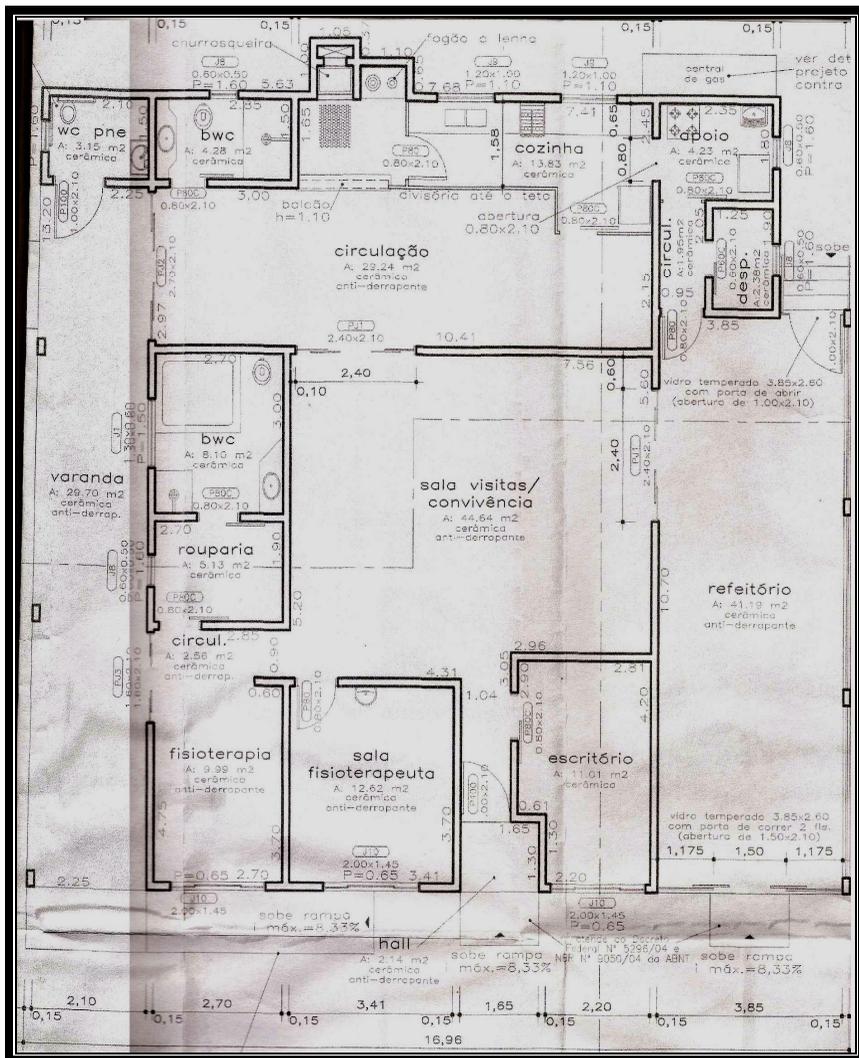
Planta Baixa da área de Convivência, Cozinha e Refeitório
